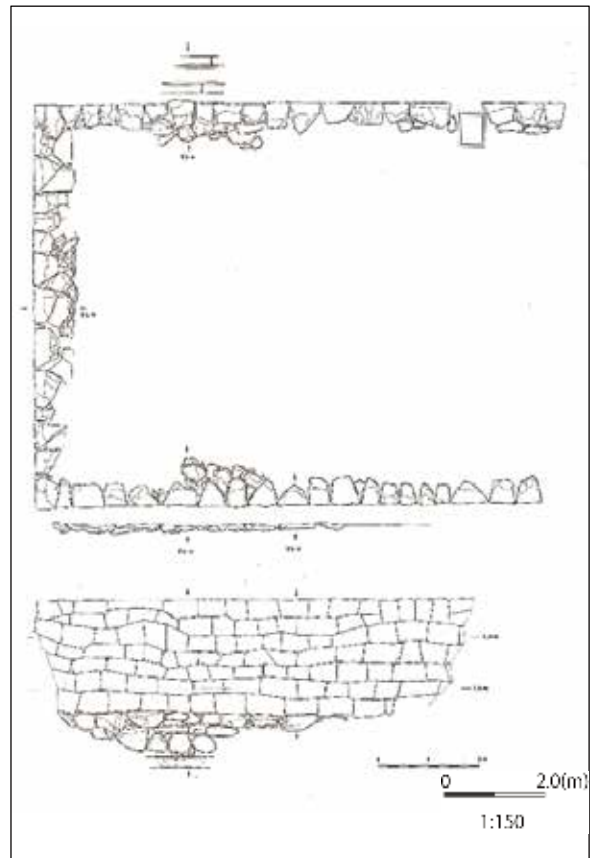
No.1-③ 江戸時代護岸石垣平面図・立面図
